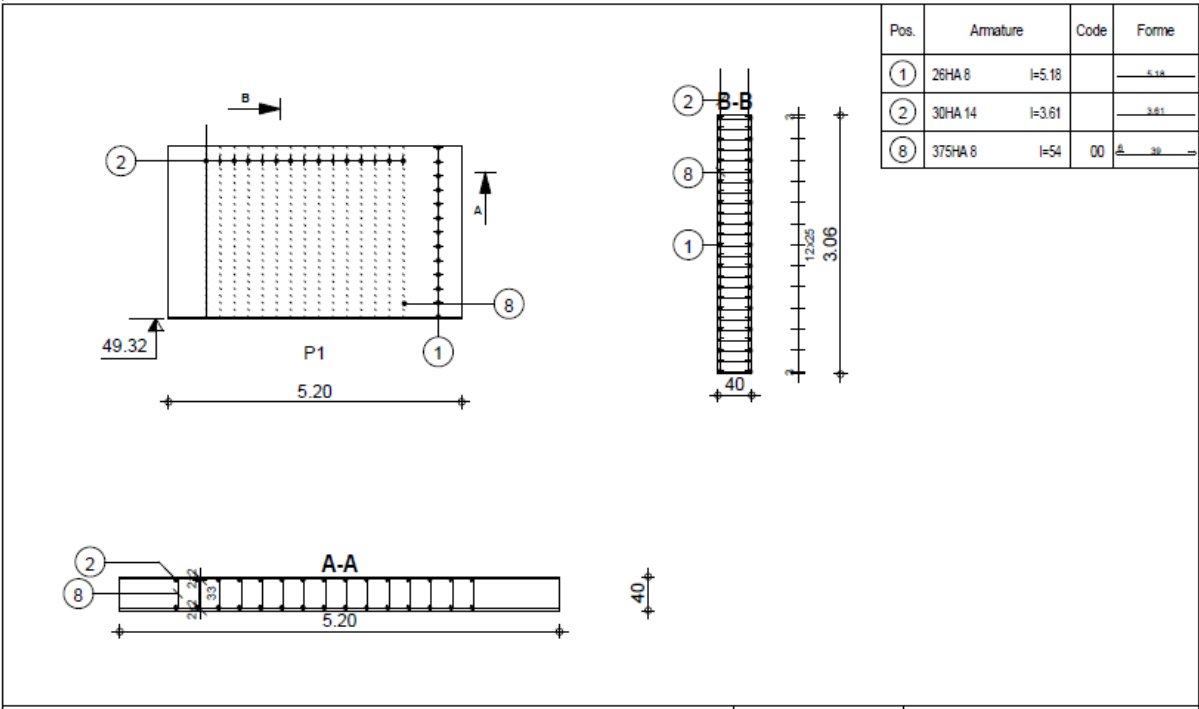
Ferrailage du voile ($L = 5.20\text{m}$) coupe AA/BB
